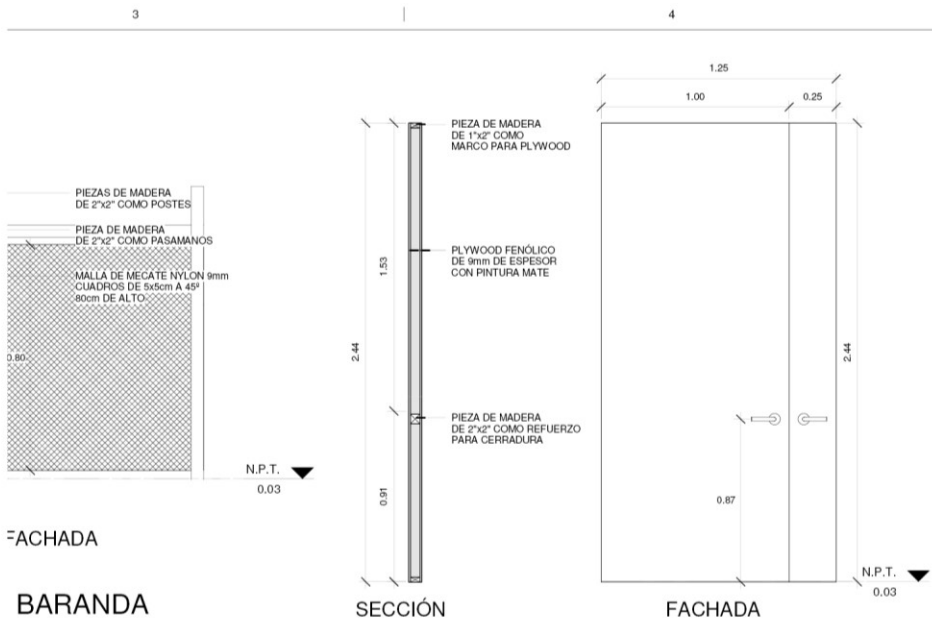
Lámina 02, planimetría de tipología A.<sup>301</sup>
